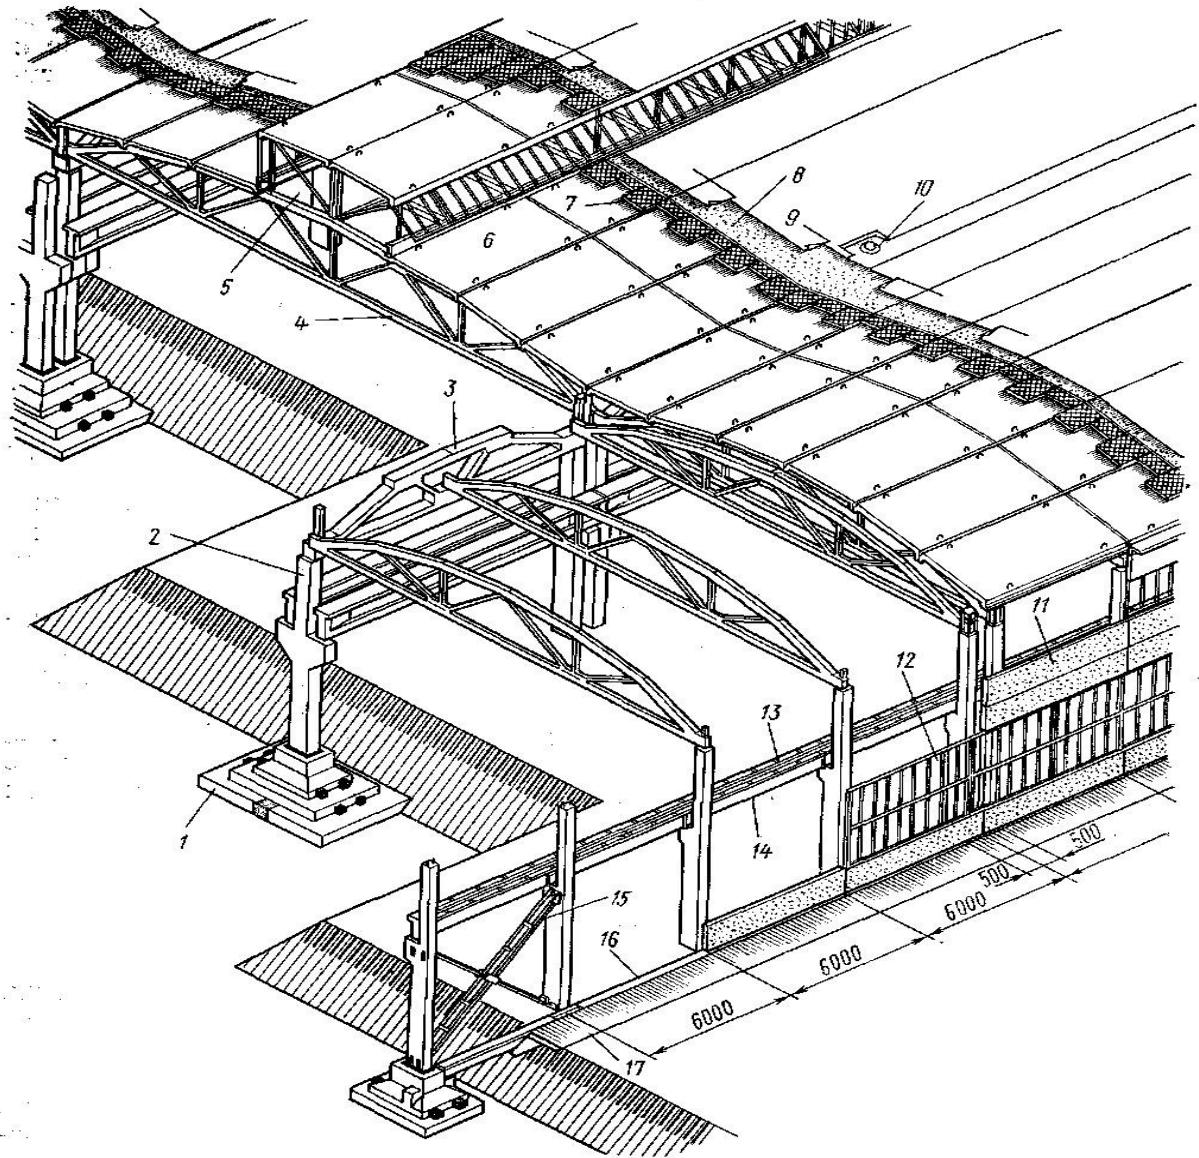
Железобетонный каркас одноэтажного здания:
